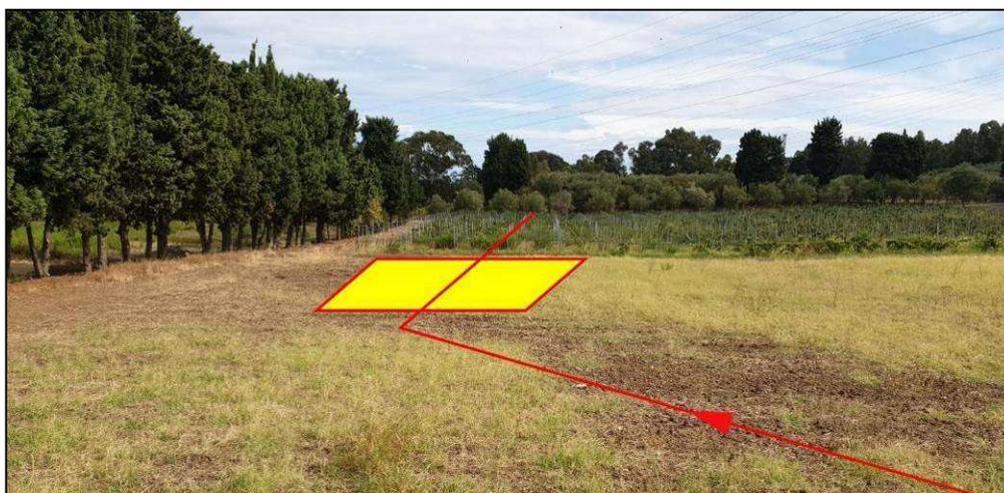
Panoramica area dell'impianto PIDS km 3+267 in progetto
